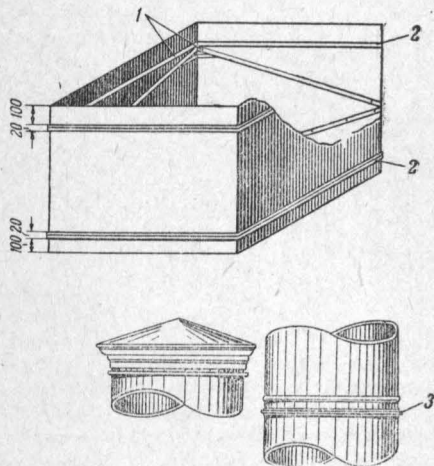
Устройство железных футляров для прямоугольной и круглой печи:
